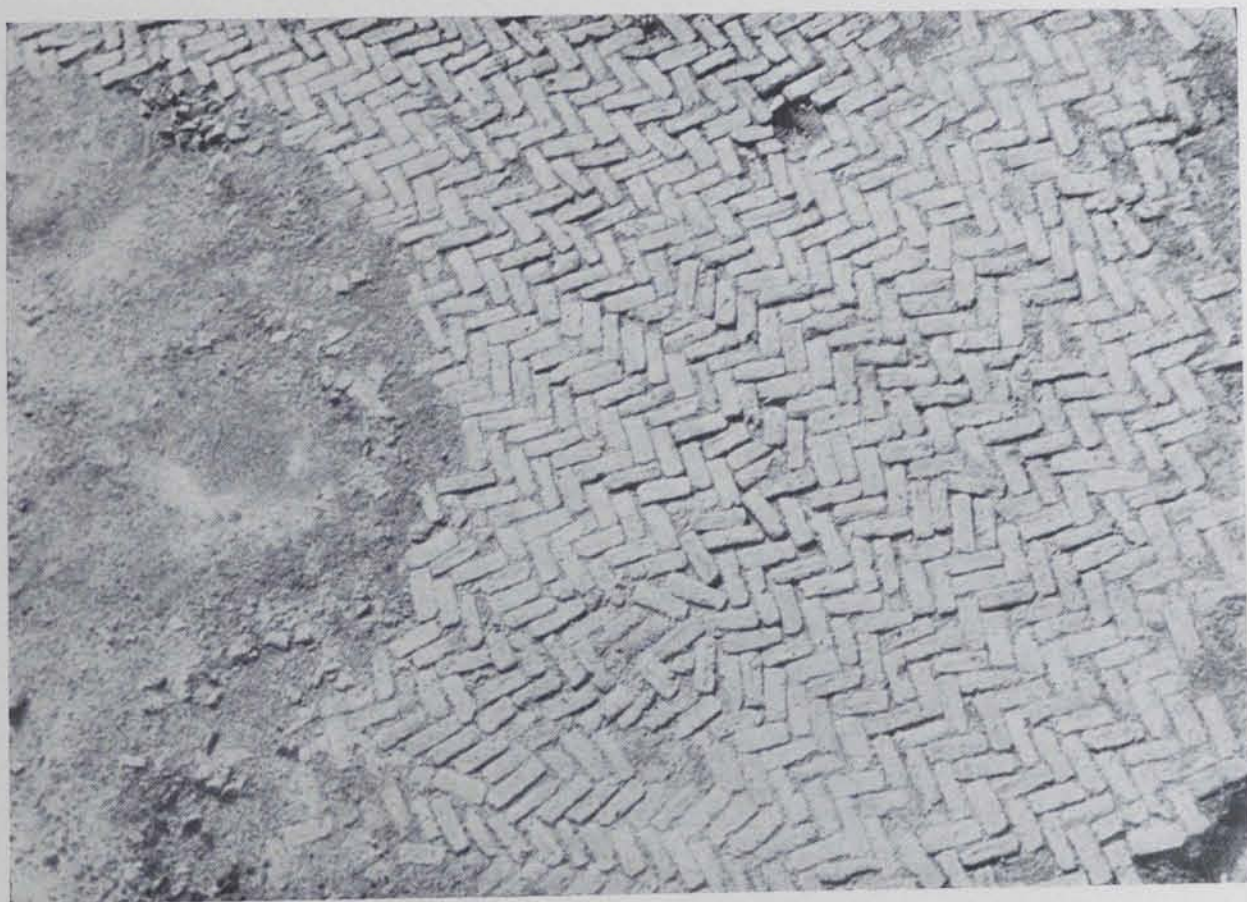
Paviment d'un pati, format de petits maons disposats en forma d'espiga
